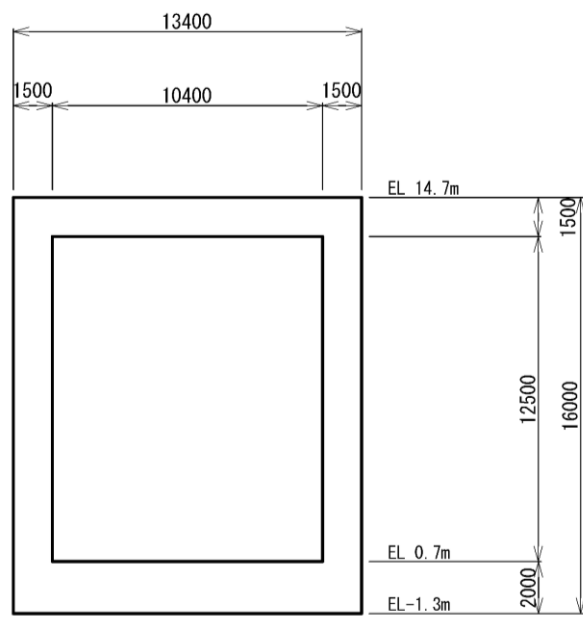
低圧原子炉代替注水ポンプ格納槽 断面図 (A-A断面)
